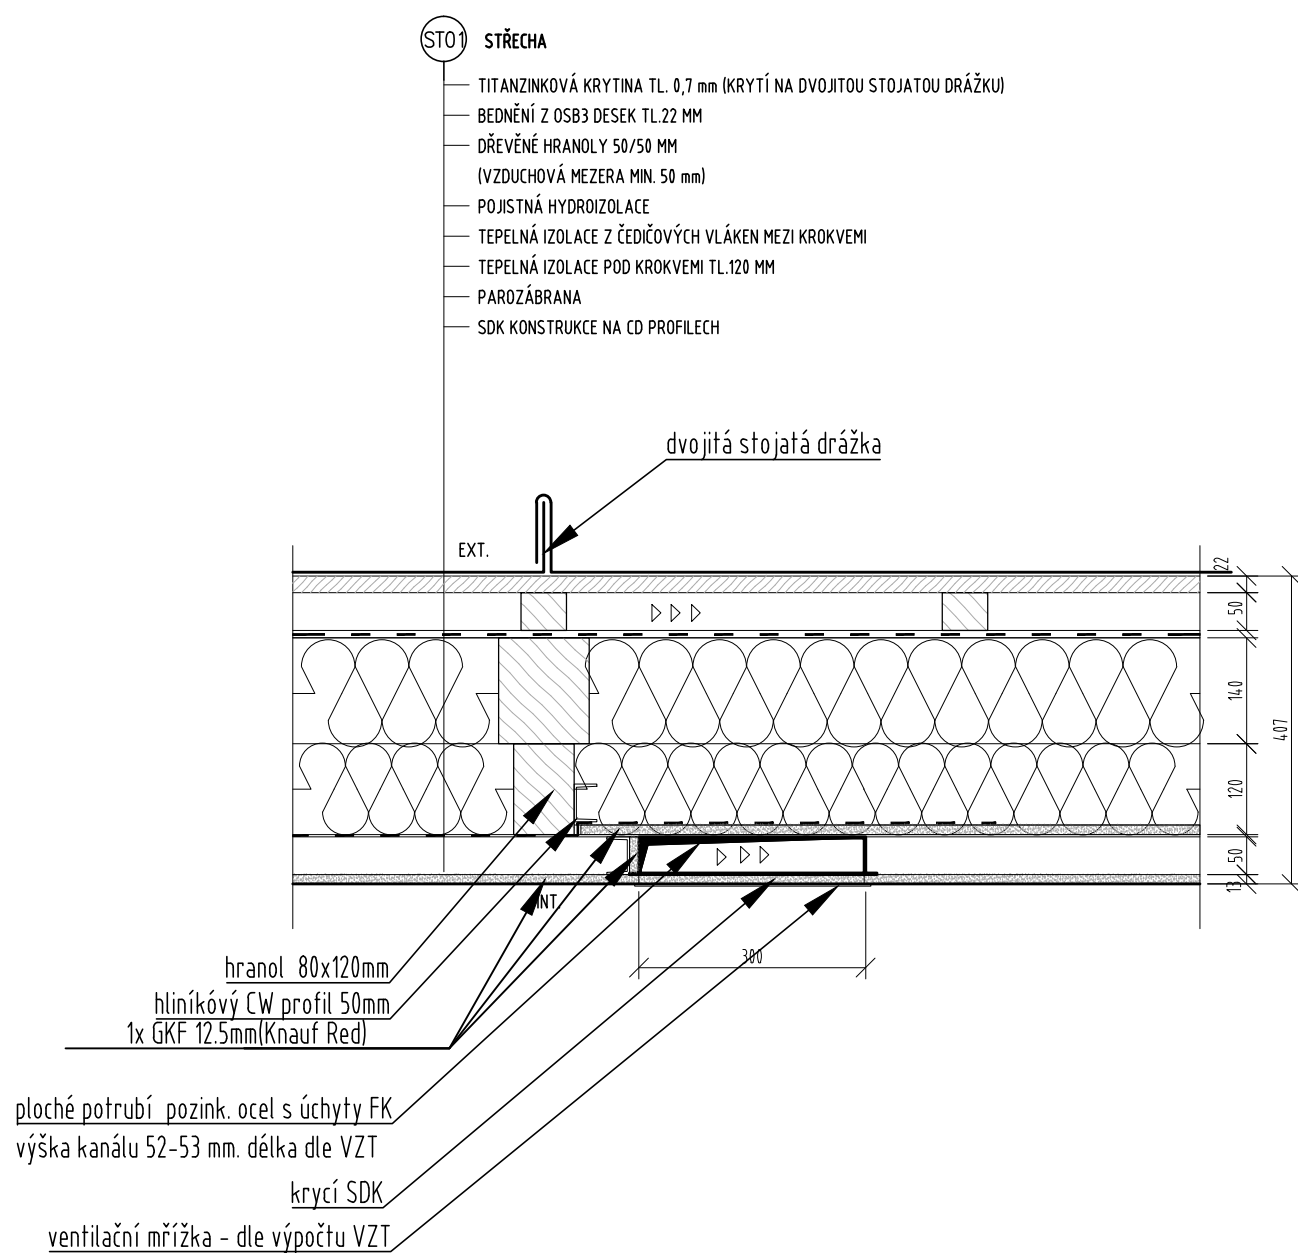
SKLADBA VENKOVNÍCH POVRCHŮ (1:10)
